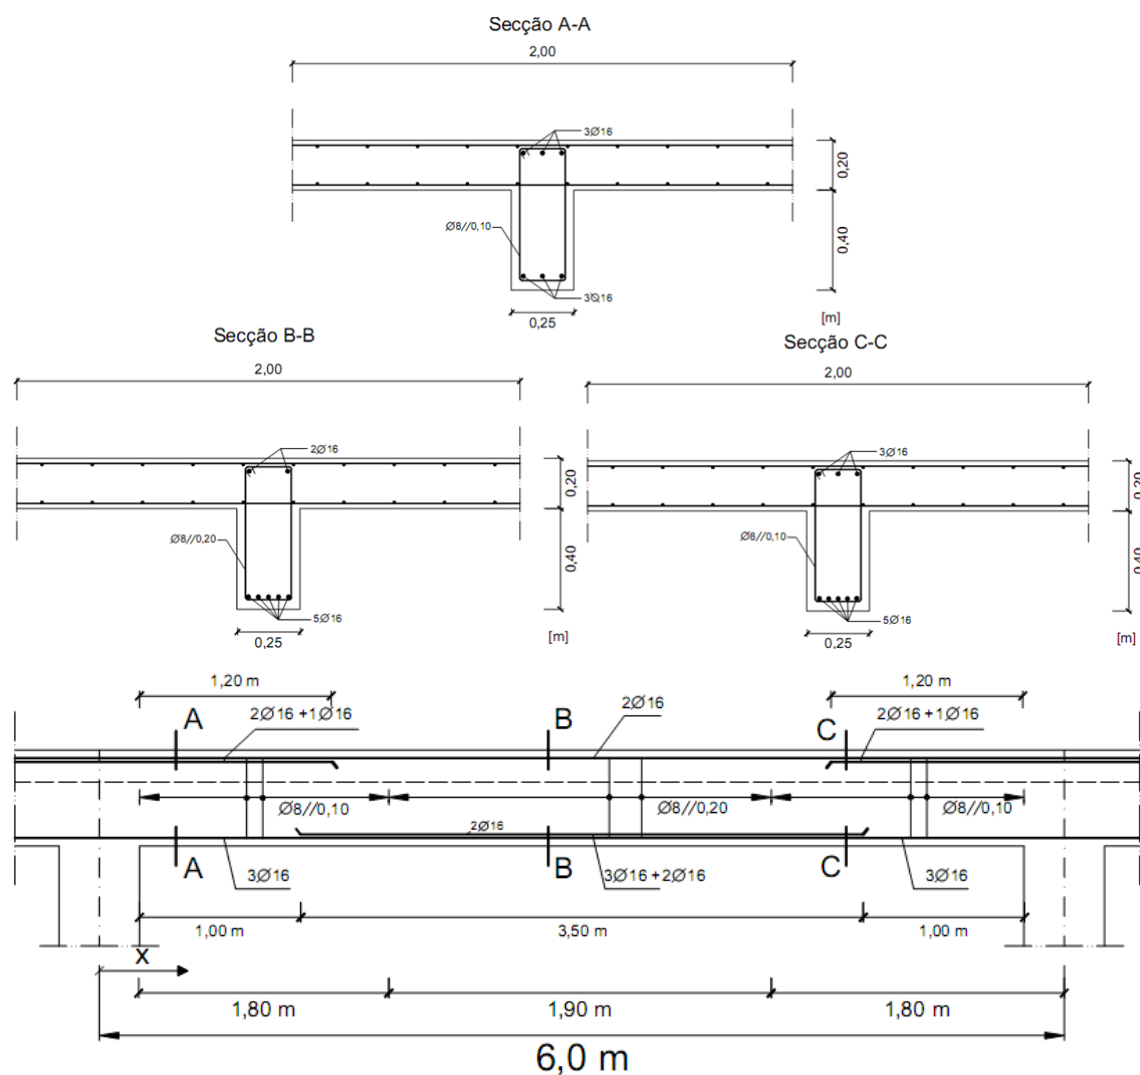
Pormenorização da armaduras (Caso D – secção em T)
